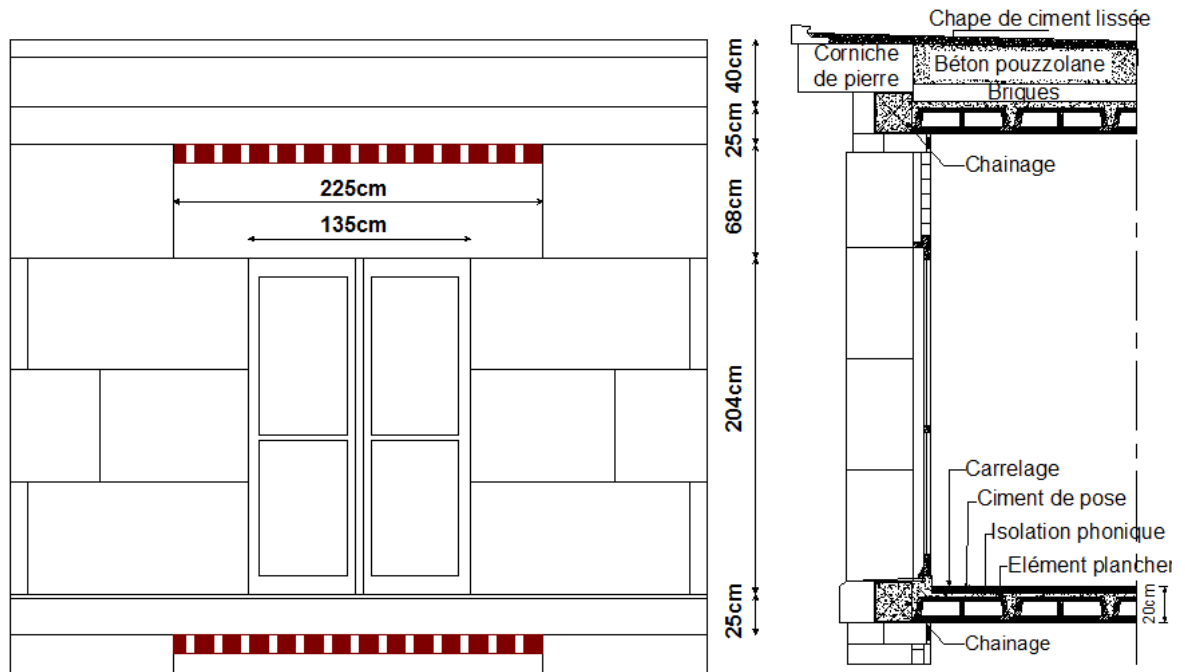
Vue en façade et en coupe du dispositif de ventilation spécial Pouillon.
